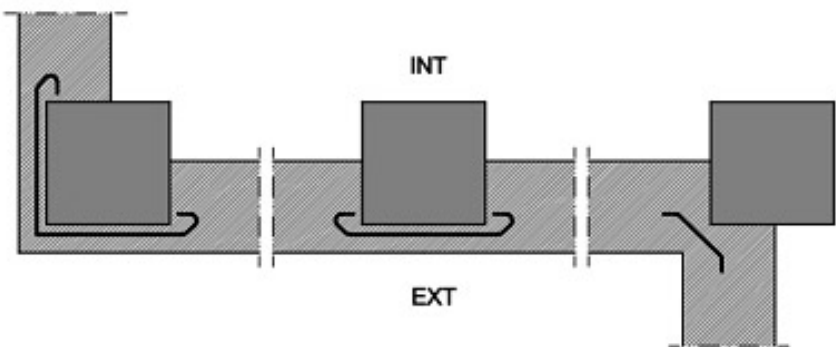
Ejemplo de encuentro de la fachada con los pilares
